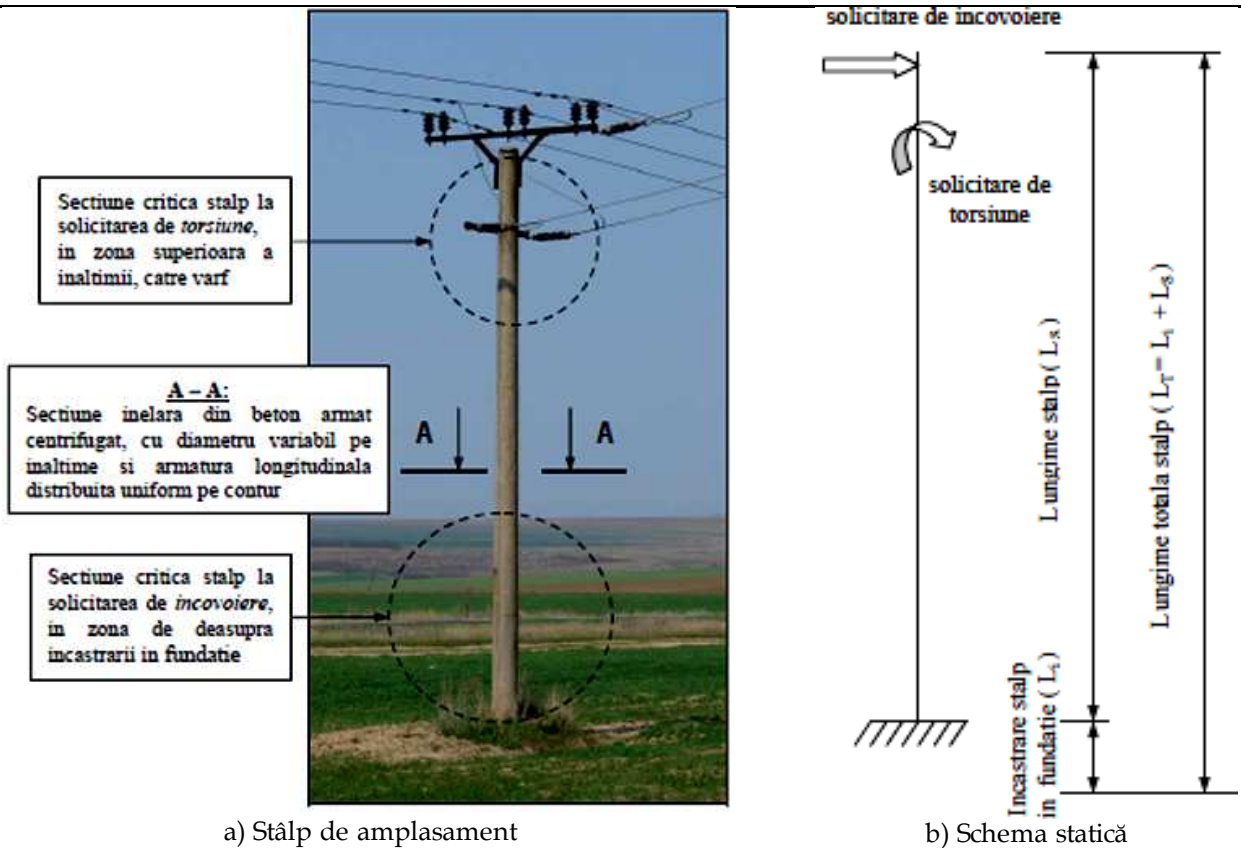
Stâlp centrifugat din beton precomprimat prefabricat cu secțiune inelară utilizat în cadrul liniilor electrice aeriene. Schema statică și zone caracteristice de solicitare.
